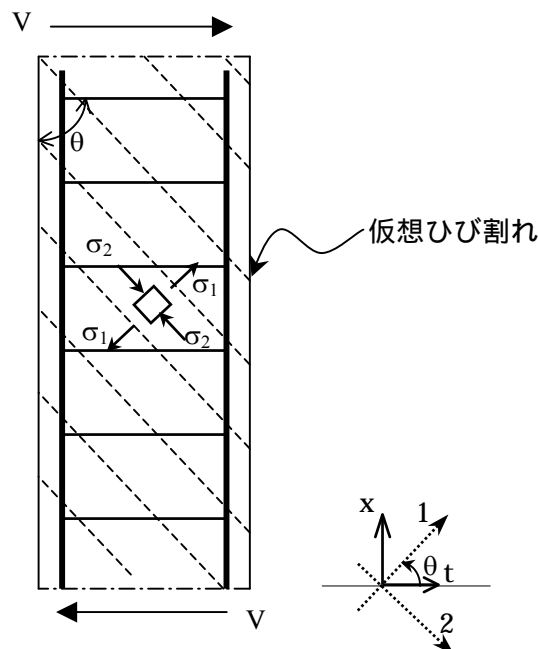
斜めひび割れが発生した鉄筋コンクリート要素
